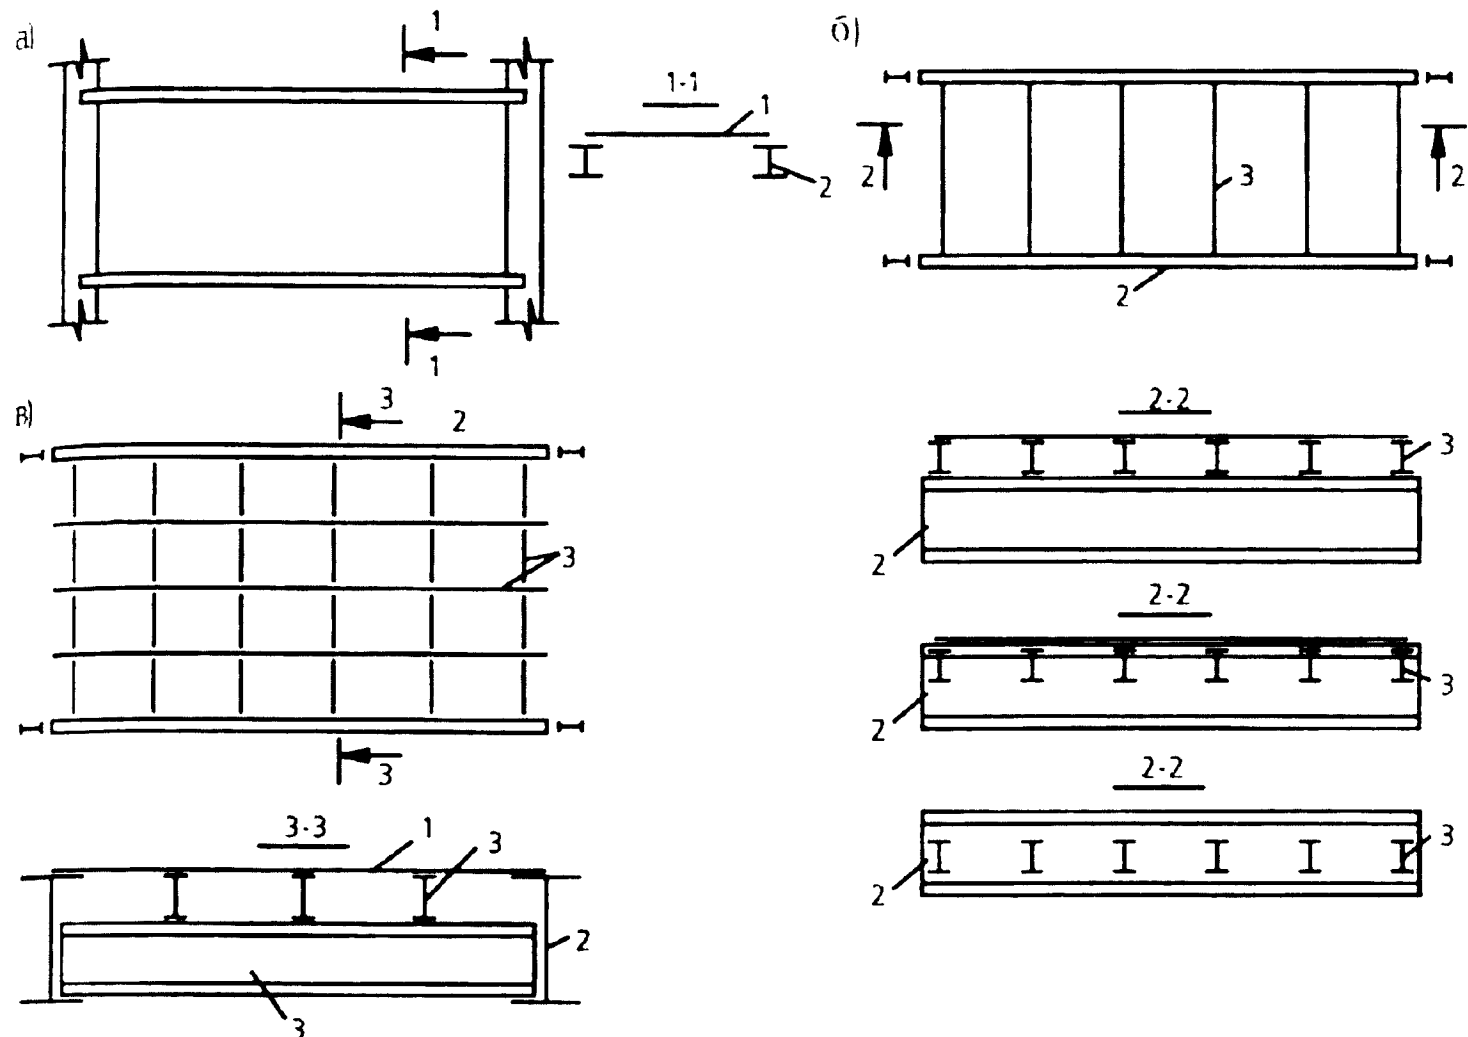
Типы балочной клетки: а - усиленная; б - нормальная; в - усложненная. 1 - настил покрытия или перекрытия; 2 - главная балка; 3 - вспомогательная балка
